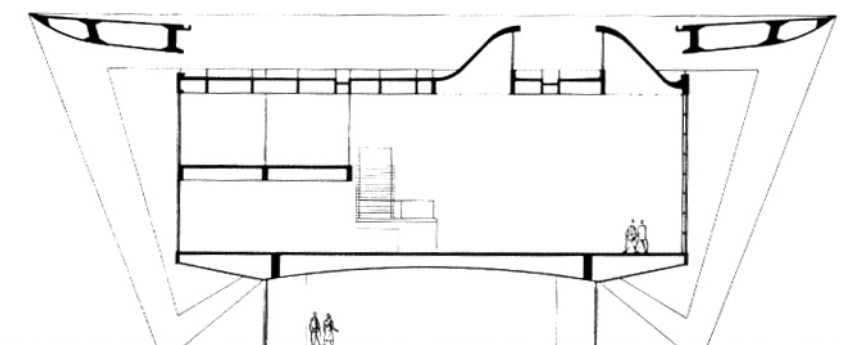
MAM RJ. Corte transversal da galeria de exibições.
